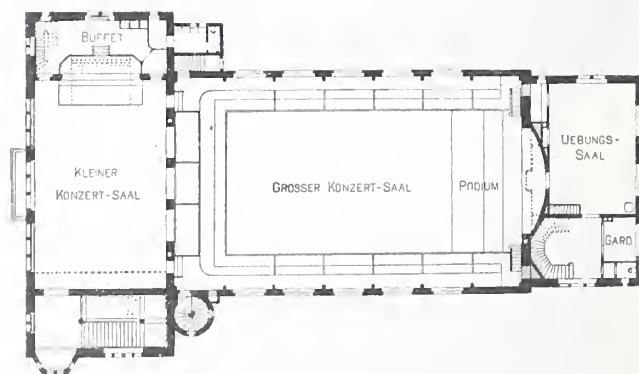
Saalbau. — Grundriss vom Obergeschoss. — 1:600.
